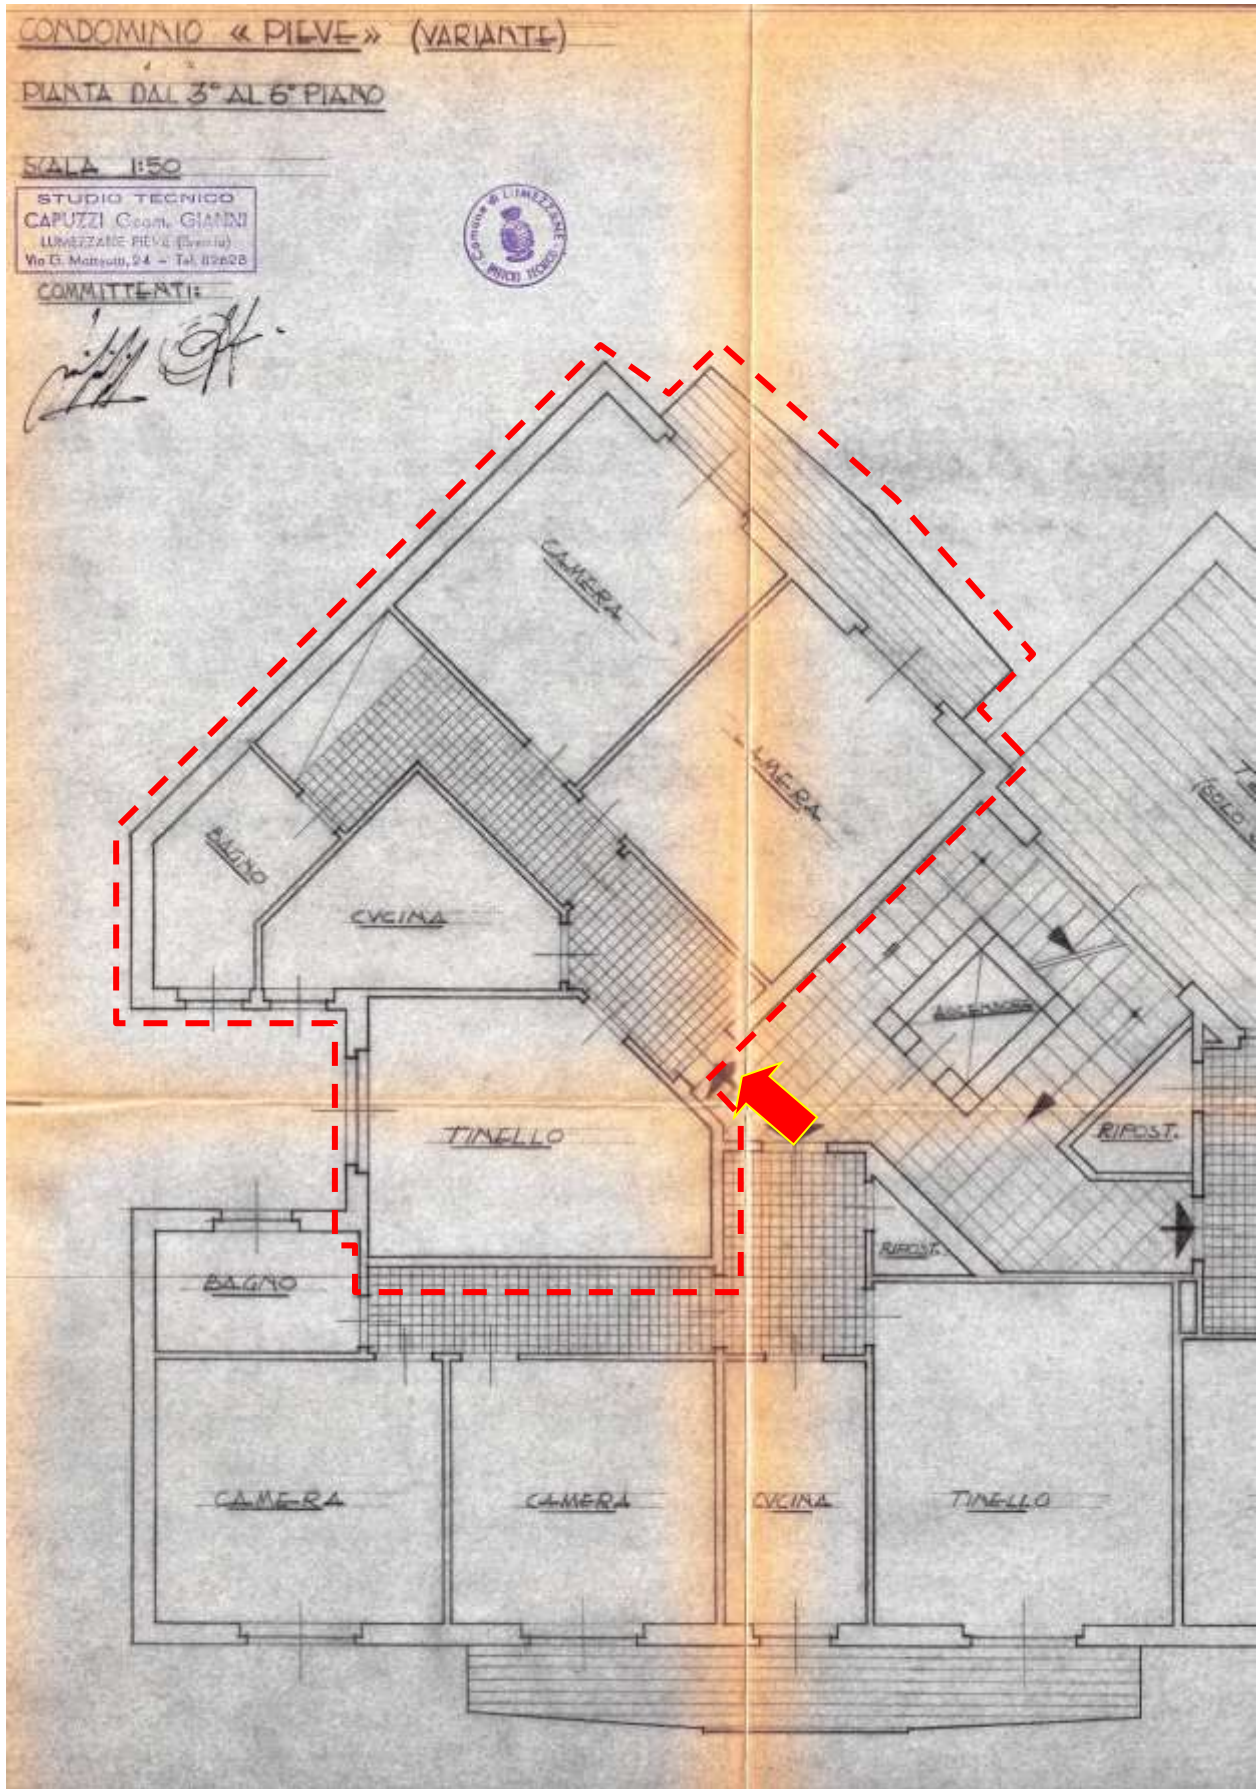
Licenza Edilizia n°461/6 del 17/10/1963, stralcio tavola di progetto (VARIANTE) del piano tipo dal 3° al 6° con perimetrazione dell'immobile così come a progetto
